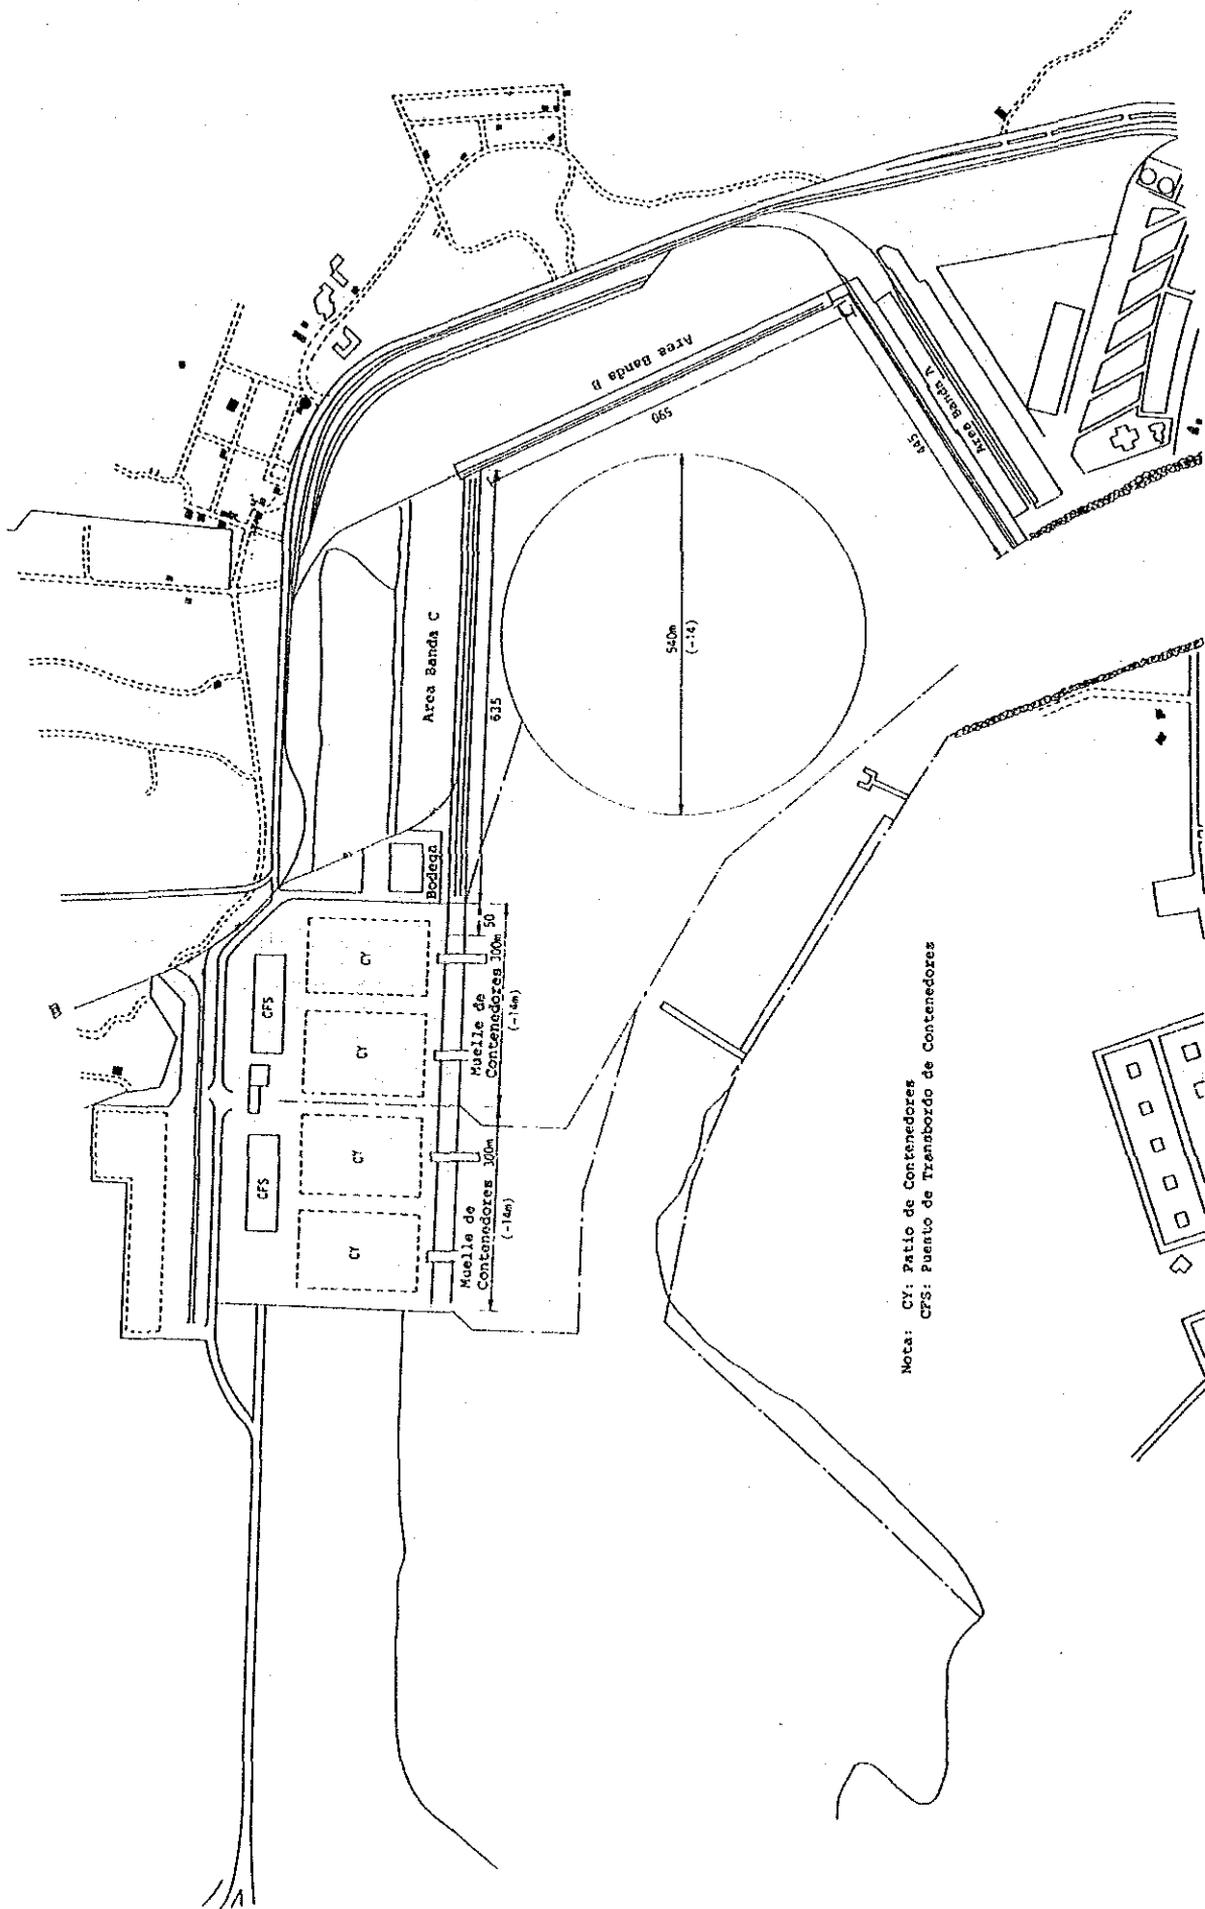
Plan de Disposición General para Carga Contenerizada (Puerto de Manzanillo 2005)
